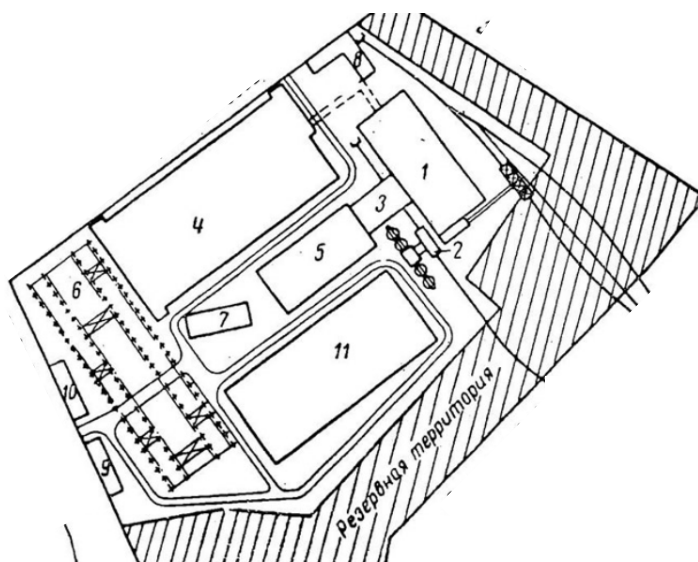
Типовой стройгенплан завода железобетонных конструкций
